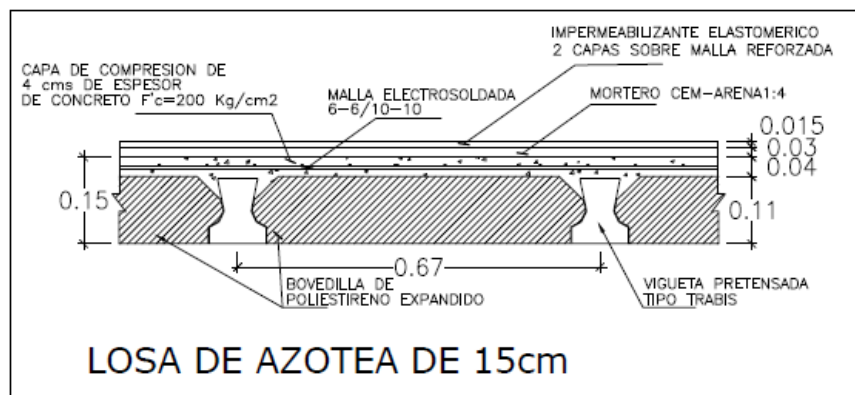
Sistema constructivo de losa de azotea de diseño de vivienda.
